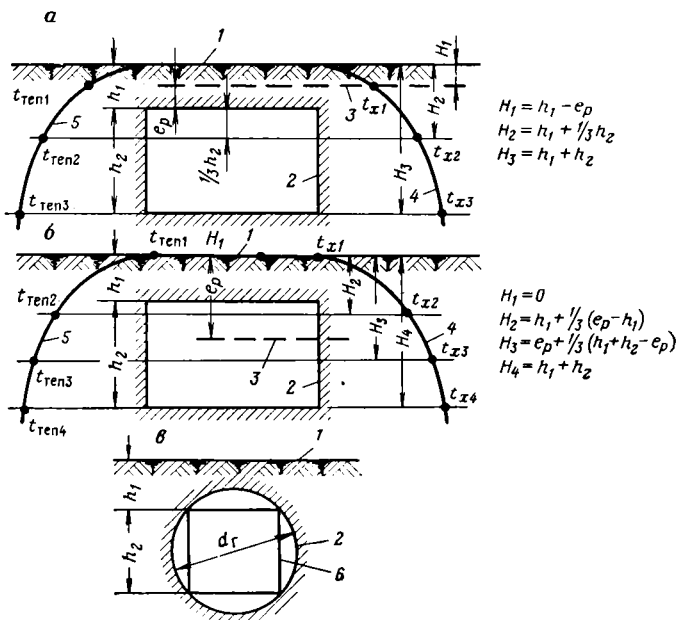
V. Схема к расчету температуры грунта для тоннелей прямоугольного и круглого сечения: при $h_1 > e_p$ (а), $h_1 < e_p$ (б) и круглого сечения (в): 1 — земная поверхность; 2 — наружный контур тоннеля; 3 — граница прогретого слоя грунта e_p ; 4 — кривая минимально возможных температур грунта, используемых при расчете режимов холодного периода года; 5 — кривая максимально возможных температур грунта, используемых при расчете режимов в теплый период года; 6 — условный контур тоннеля круглого сечения
